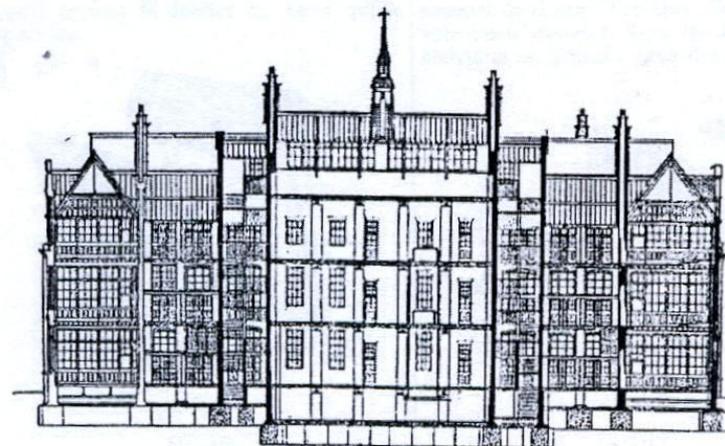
Elevação da escola da rua Ivydale, em Londres.
